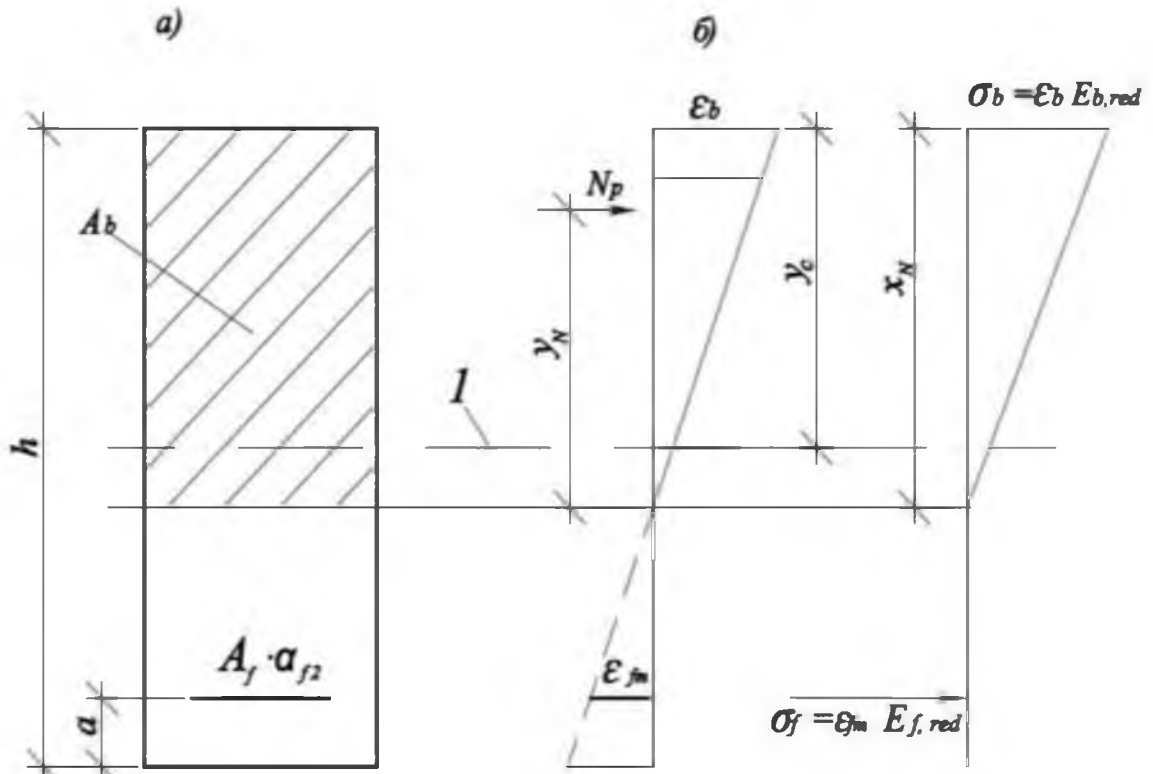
Приведенное поперечное сечение (а) и схема напряженно-деформированного состояния изгибаемой предварительно напряженной конструкции с трещинами (б) при ее расчете по деформациям.
